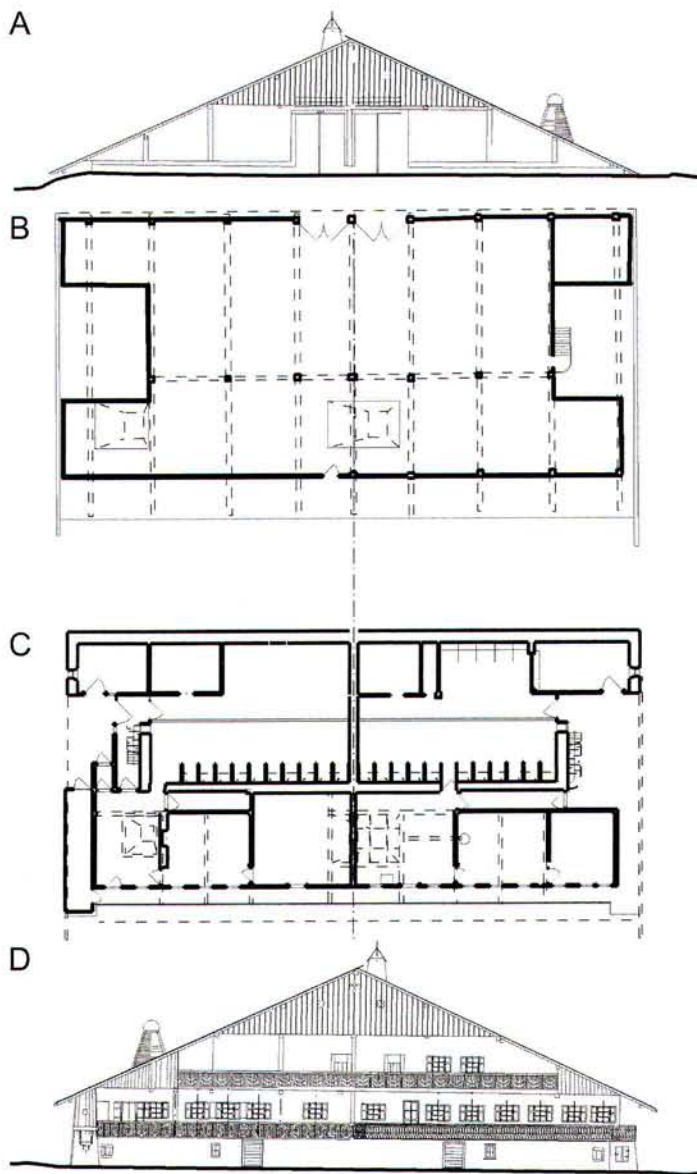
Abondance, Chez les Gay de l'Adroit, čp. 873, 875: Půdorys obytného podlaží a úrovně stodoly/seníku překreslený podle zaměření Paula Desmaresta. Enquête sur l'architecture rurale chantier 1425 (MNATP): dossier Haute Savoie 832. – Abb. 4. Abondance, Chez les Gay de l'Adroit, KNr. 873, 875: Grundriss des Wohngeschosses und der Scheunenebene/Heubodenebene, umgezeichnet nach einem Aufmaß von Paul Desmarest. Enquête sur l'architecture rurale chantier 1425 (MNATP): dossier Haute Savoie 832.
